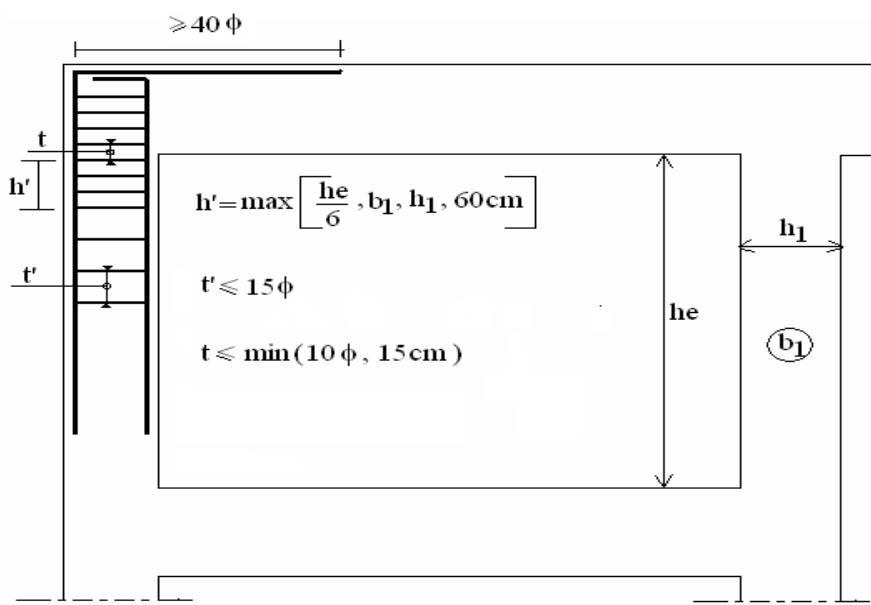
Disposition constructives pour le ferrailage des poteaux (RPA) .
